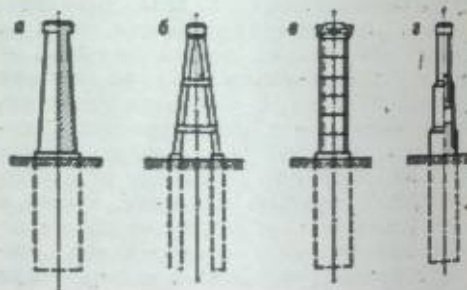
Надфундаментная часть промежуточных опор: а — монолитная; б — сборная из центрифугированных железобетонных оболочек diam. 0,4—1 м; в — из сборных железобетонных оболочек diam. 3—3,4 м; г — сборная телескопическая из оболочек diam. 1, 2, 4 и 3 м.
